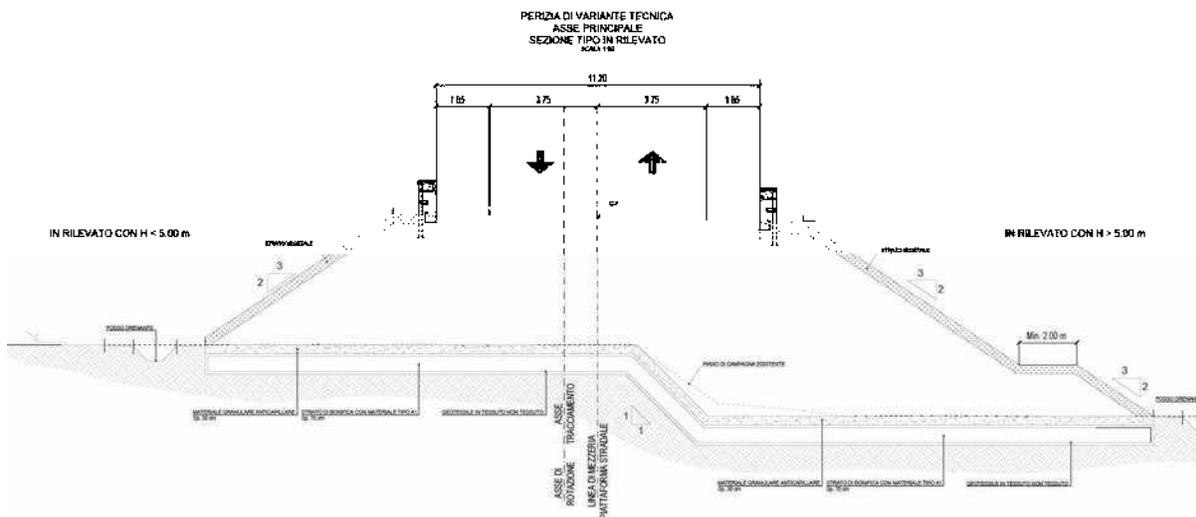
Sezione tipo in rilevato Progetto Esecutivo 2006
